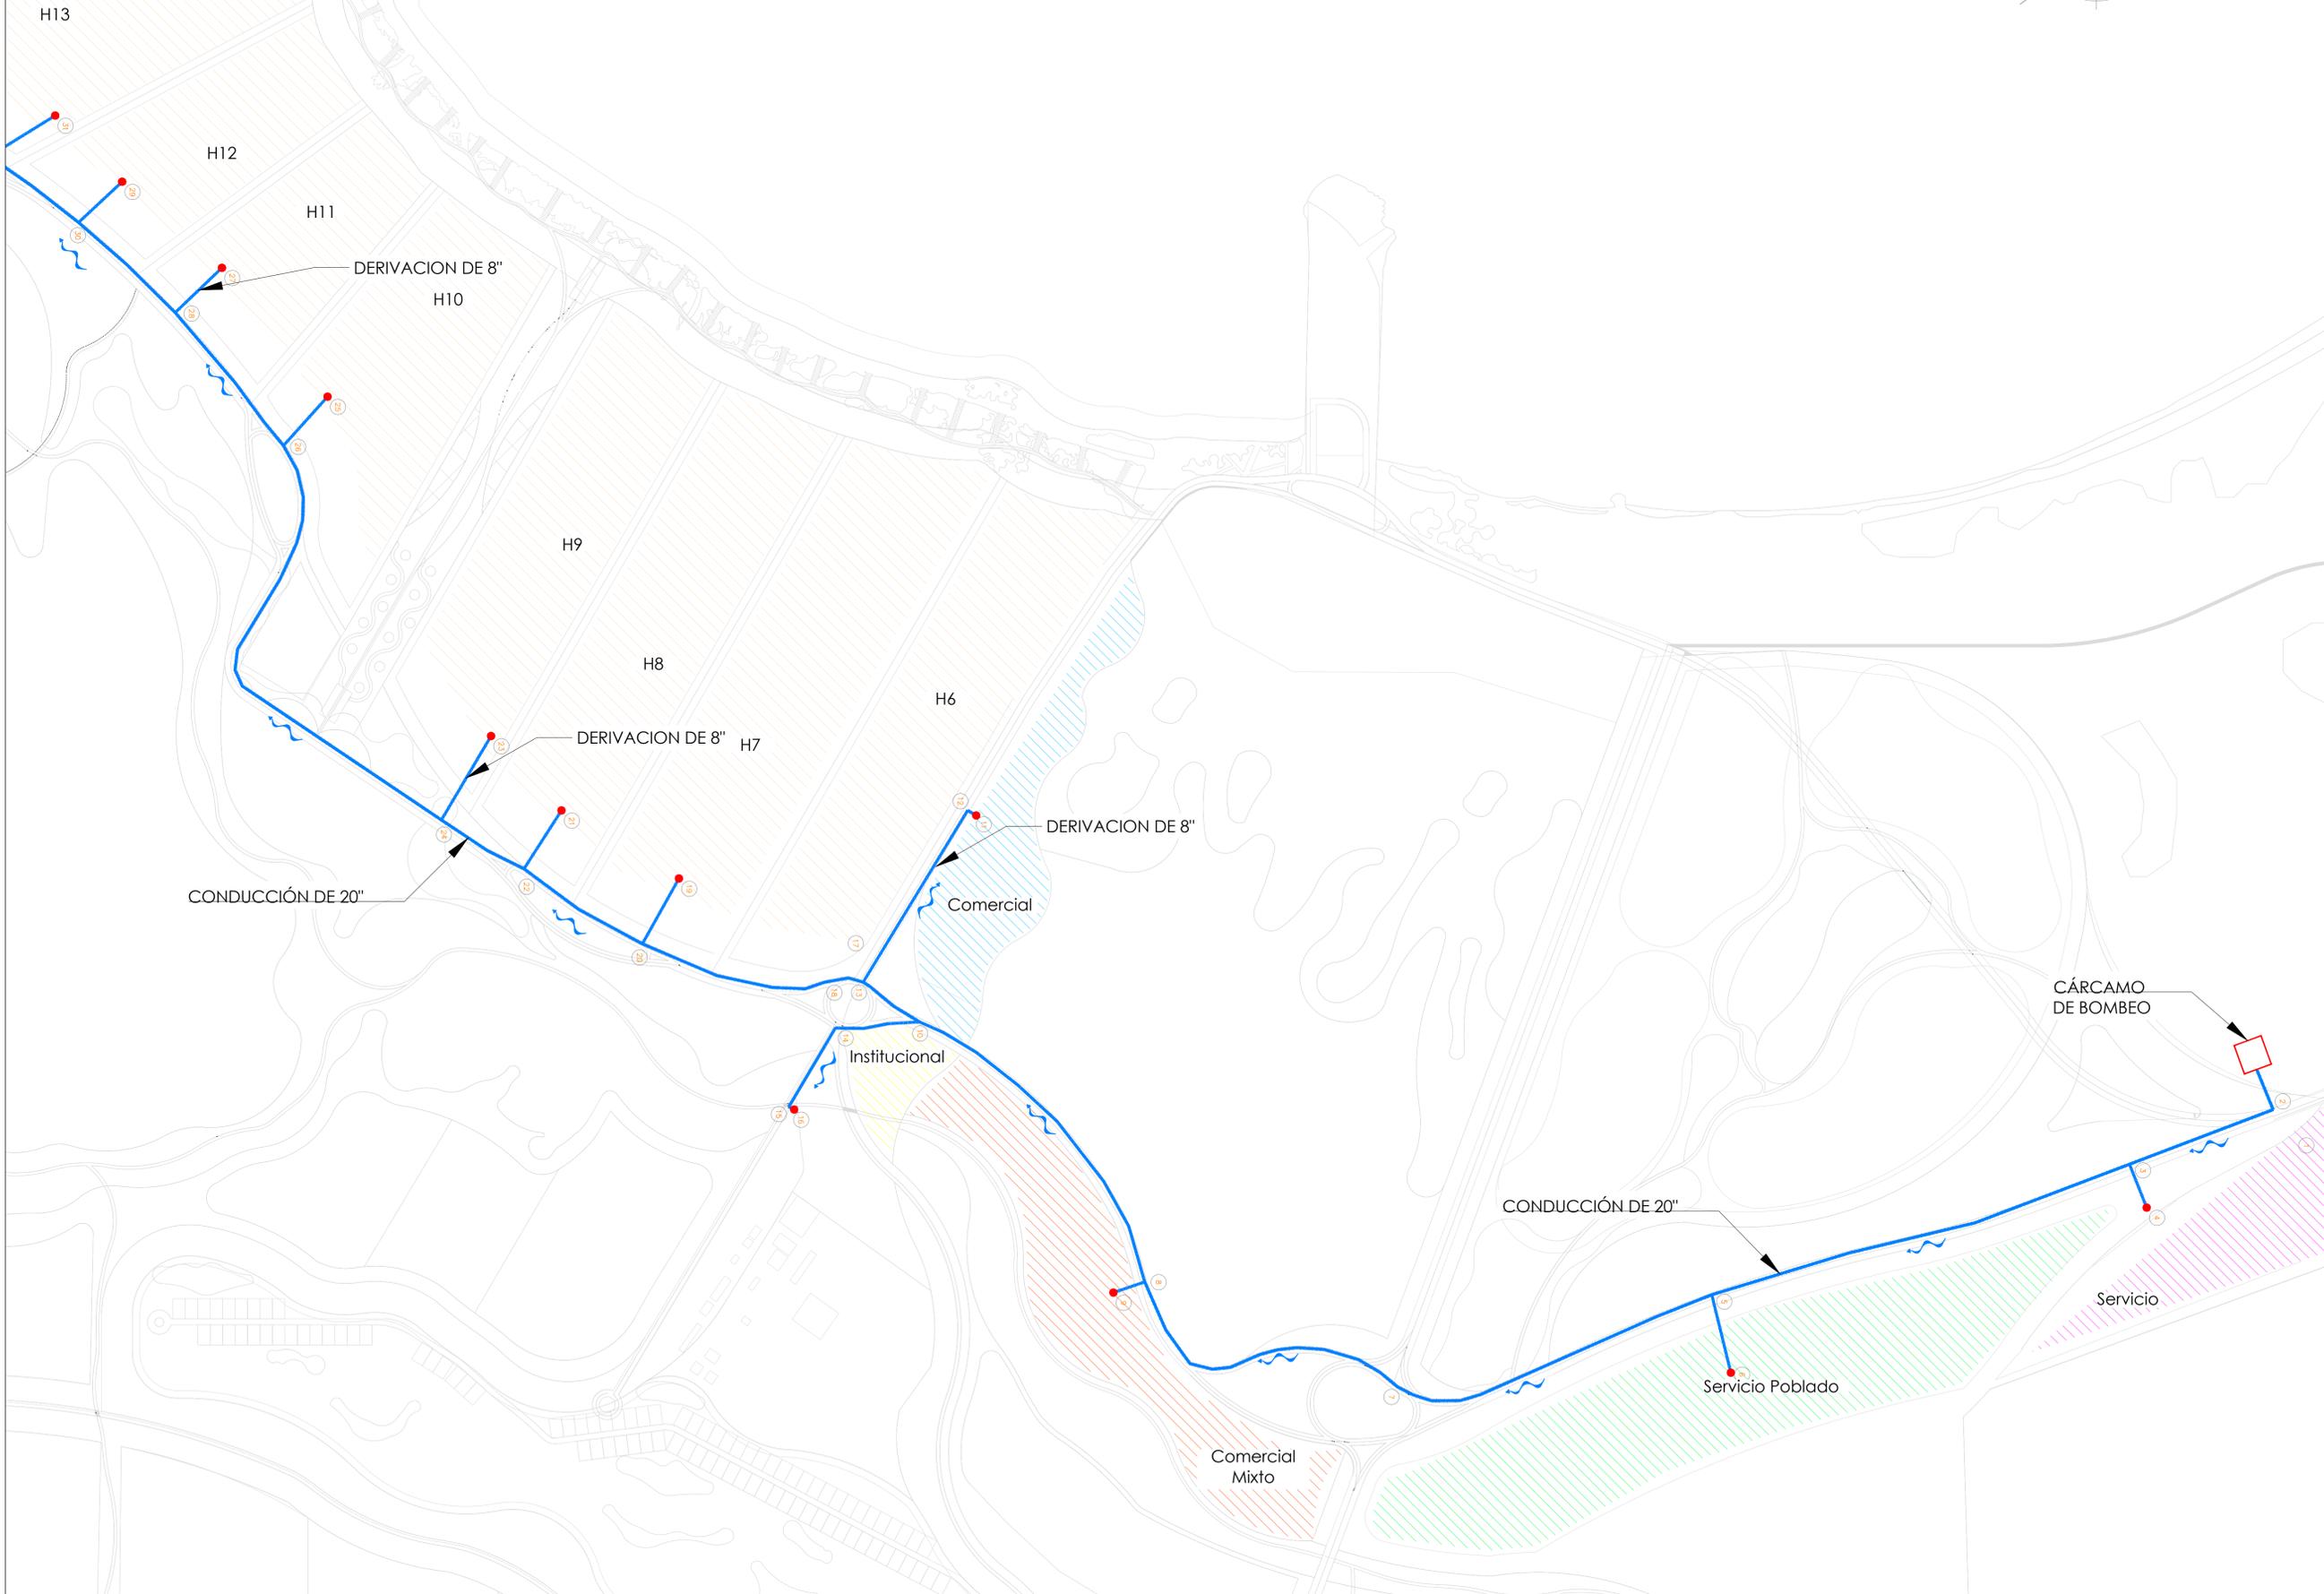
Planta general del proyecto y de la tubería de abastecimiento
